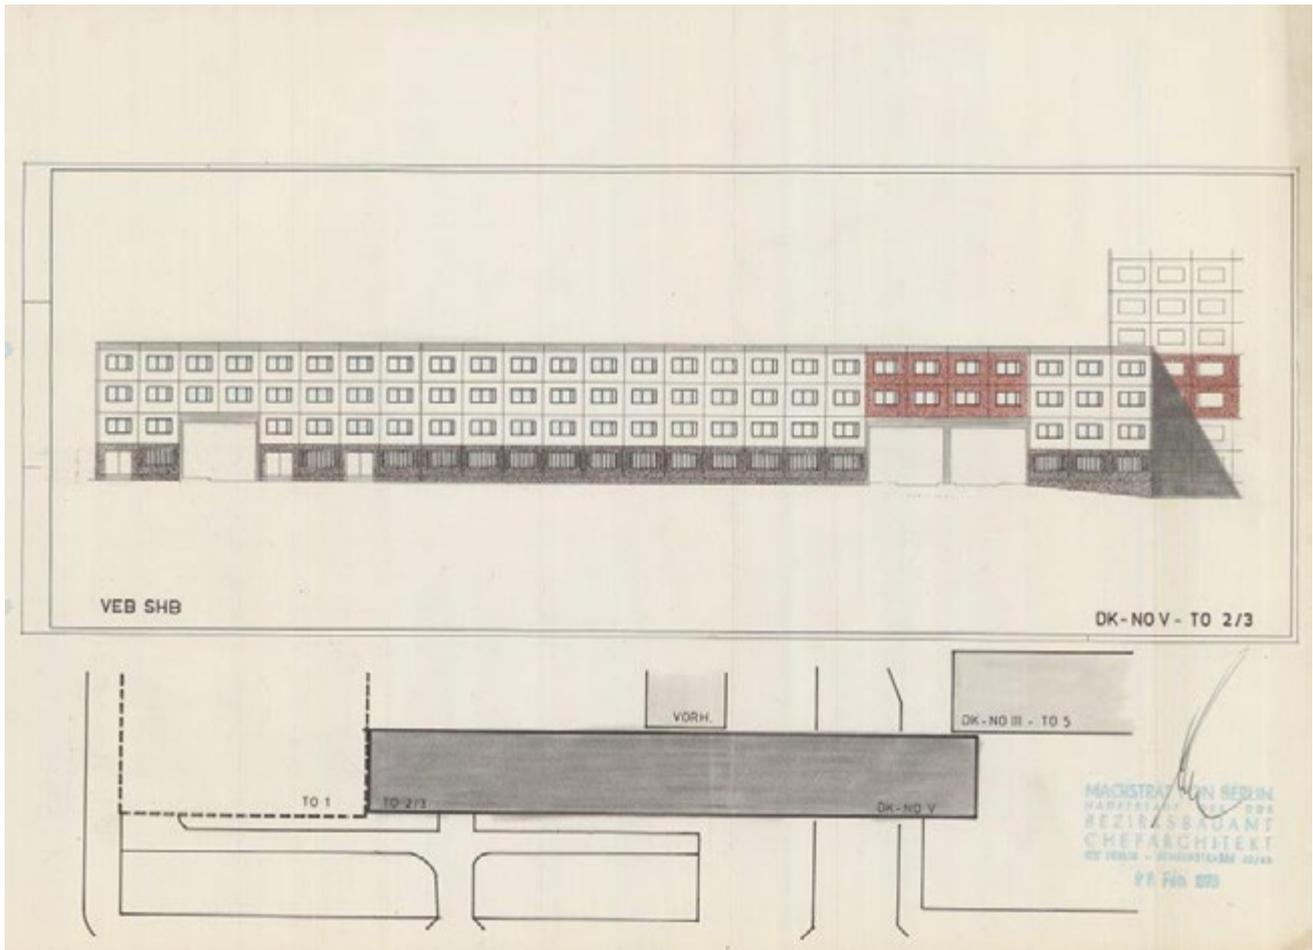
Projektierung der SHB (Spezialhochbau Berlin) 1978 [Landesarchiv]
